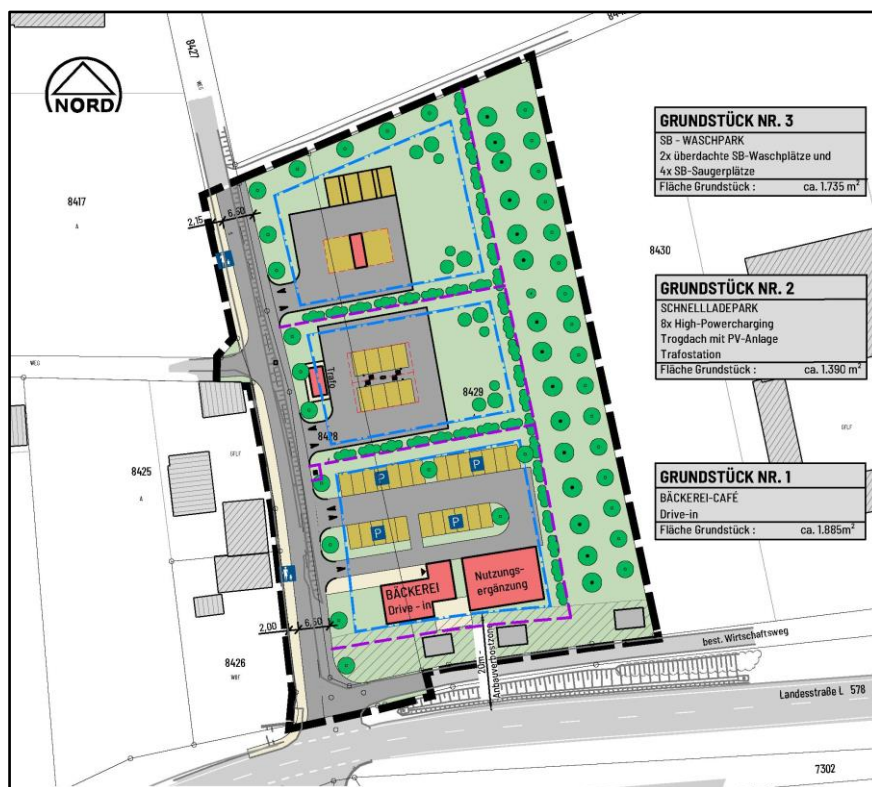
Bebauungsplan „Obere Zeil“, Städtebauliches Konzept -Vorentwurf mit Stand 12.09.2023
